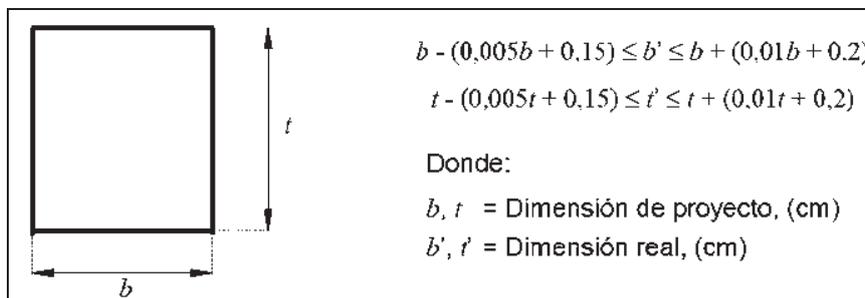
Tolerancia para la sección transversal de trabes o columnas [16].
